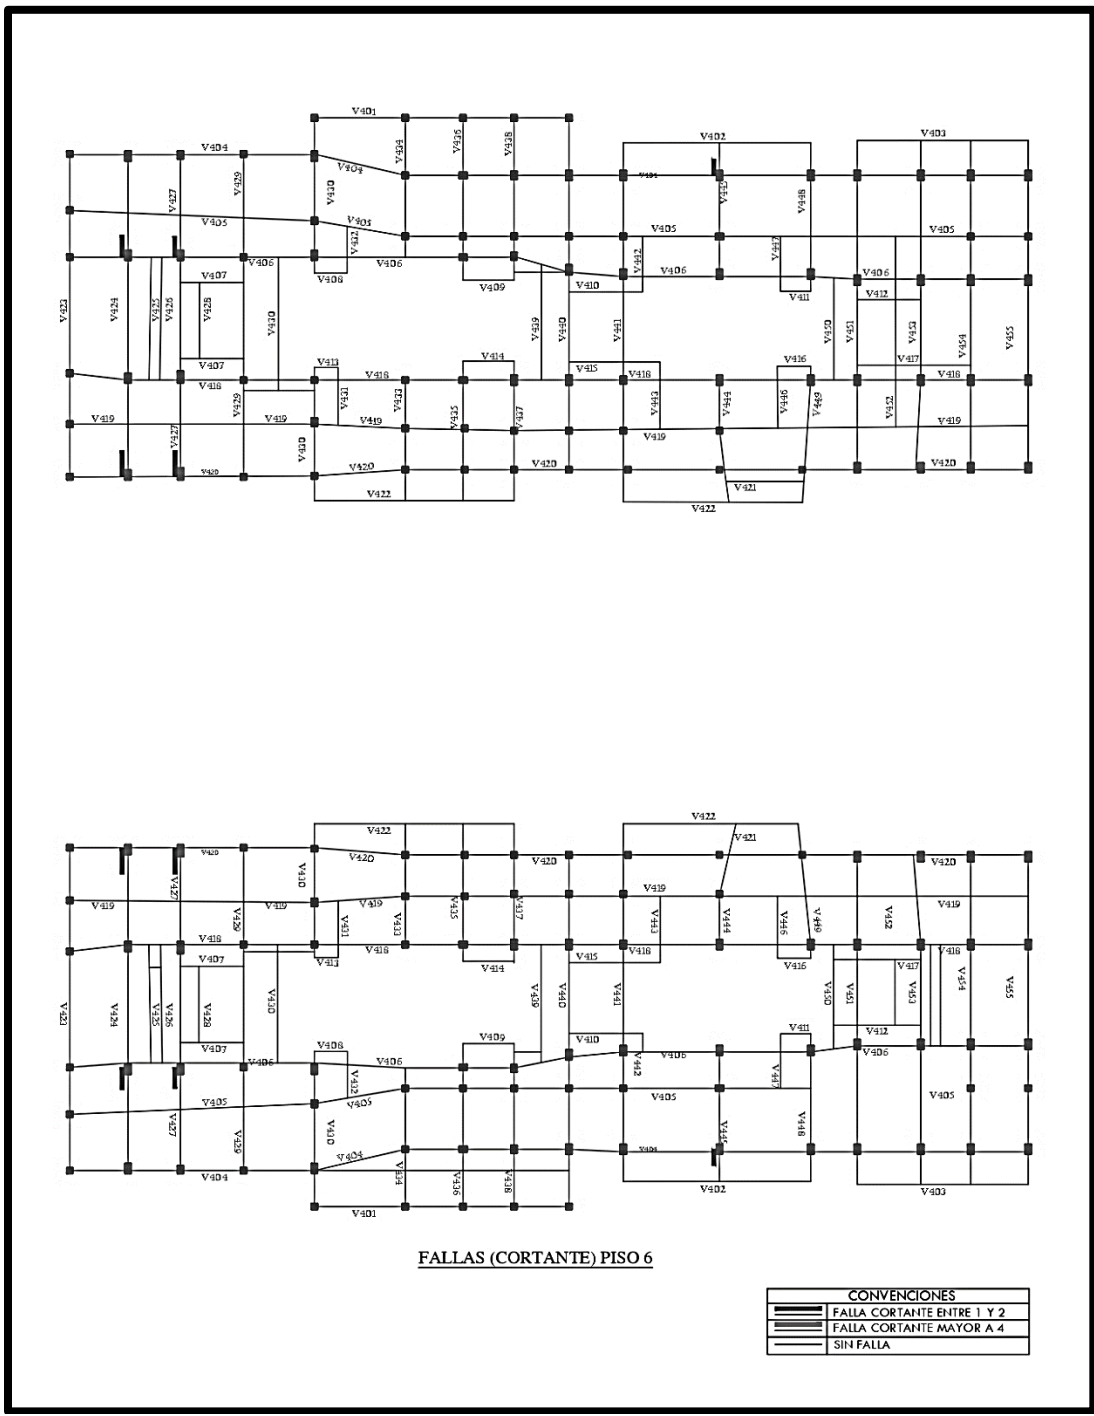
Plano de secuencia de fallas (Cortante) piso 6. Fuente: Los autores
